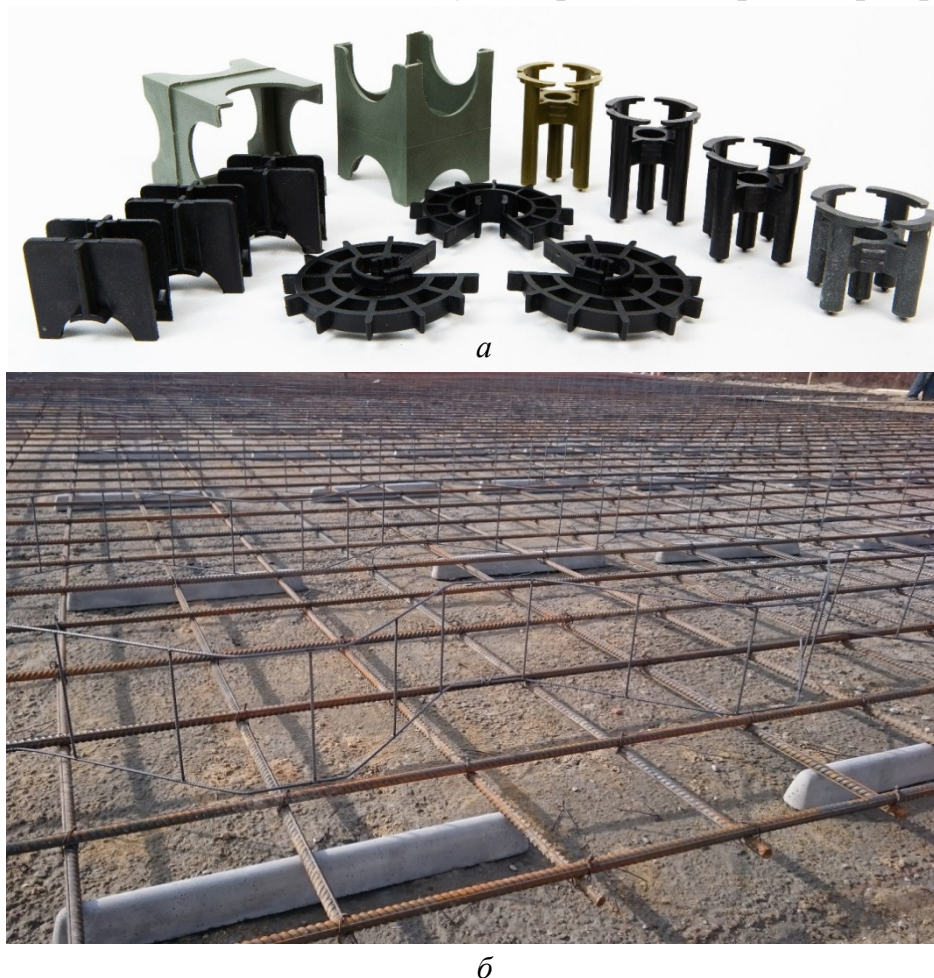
Фиксаторы арматуры в ж/б конструкциях:
